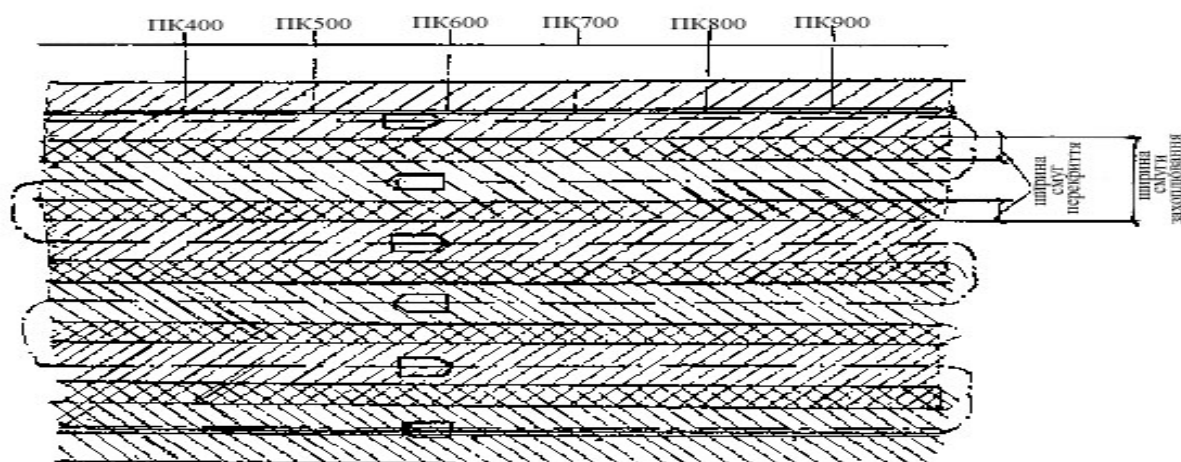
Схема розташування подовжніх галсів на ділянці каналу з перекриттям.
